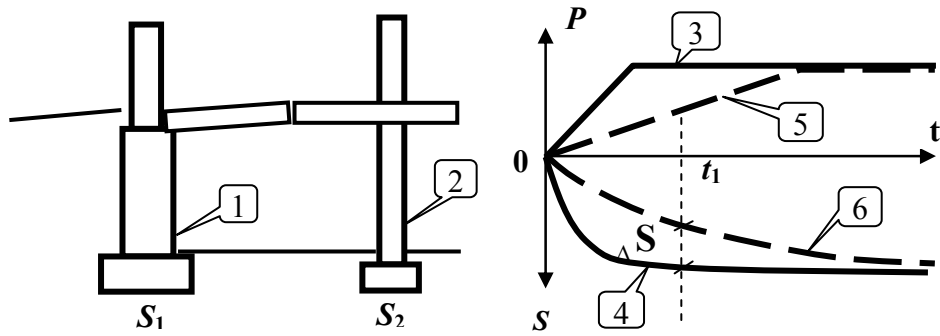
Неравномерные осадки уплотнения при одновременном загрузении фундаментов: 1 – первый фундамент; 2 – второй фундамент; 3 – нагрузка на первый фундамент; 4 – осадка первого фундамента; 5 – нагрузка на второй фундамент; 6 – осадка второго фундамента
